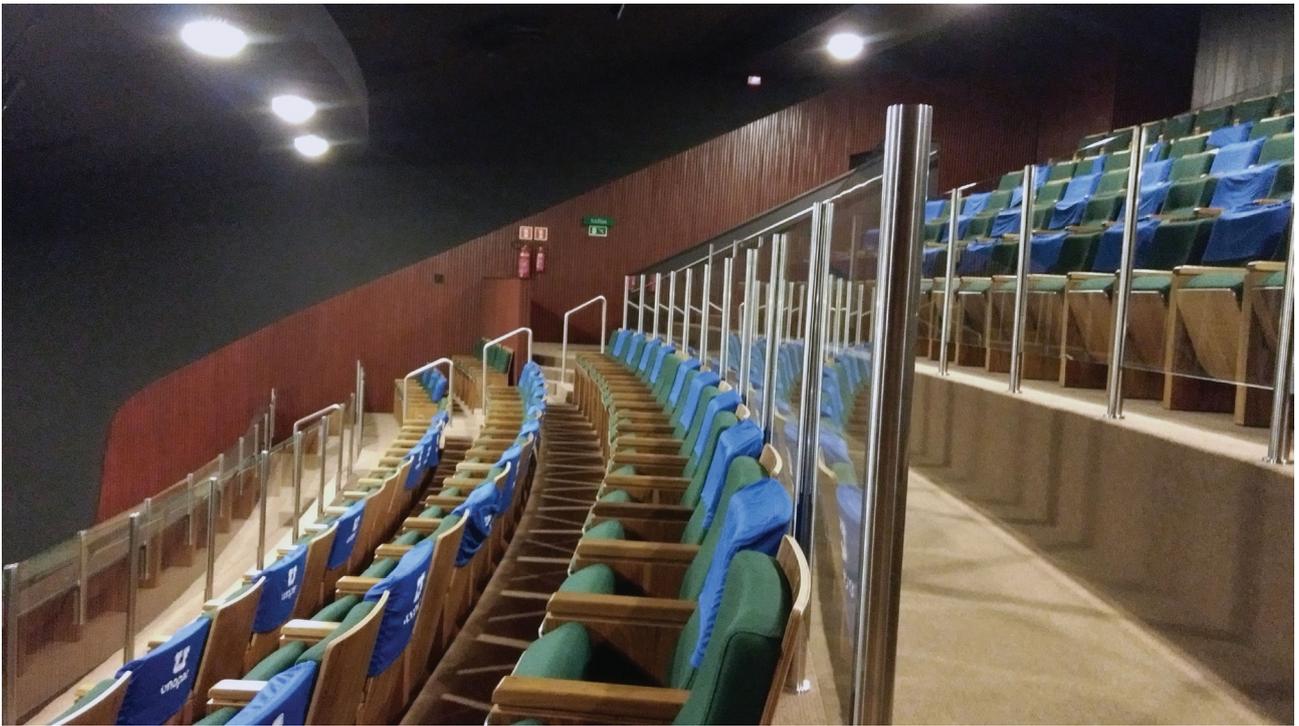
| Vista das cadeiras do balcão com guarda-corpos em estrutura metálica e vidro.
